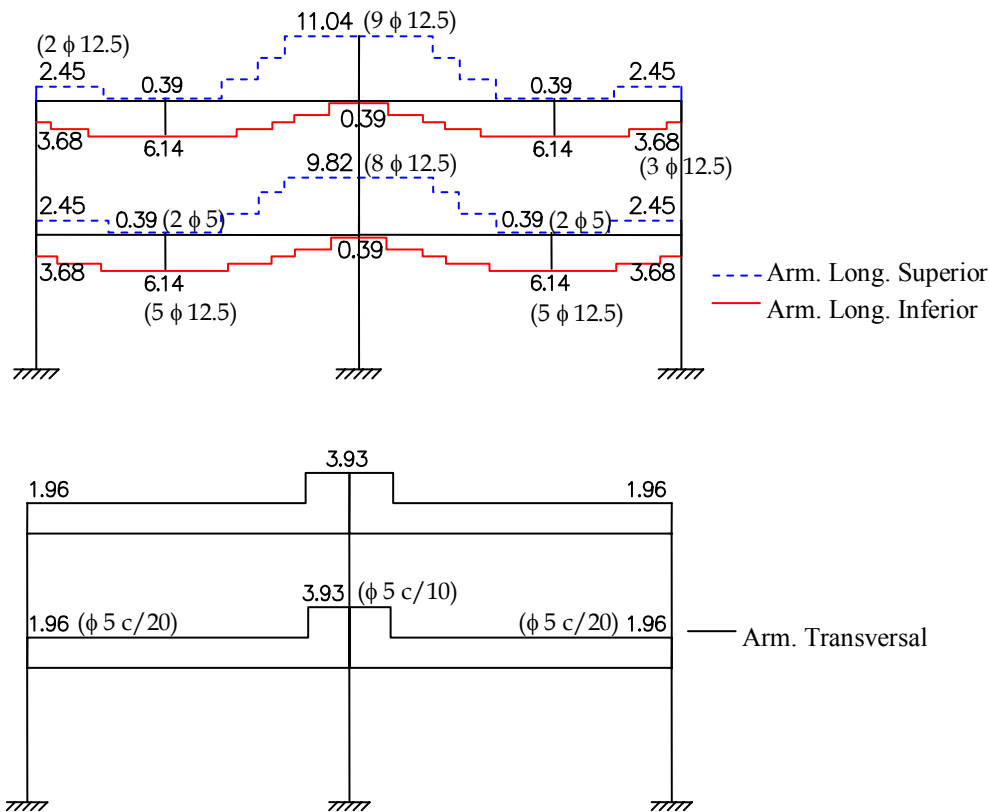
Diagramas de armadura adotada do pórtico plano do Exemplo 2.
